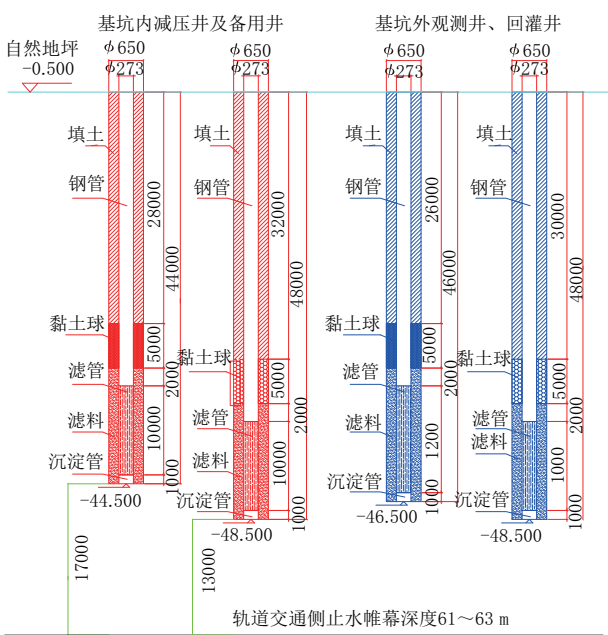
基坑内减压井及其备用井、基坑外观测井及回灌井结构剖面图(单位:mm)
